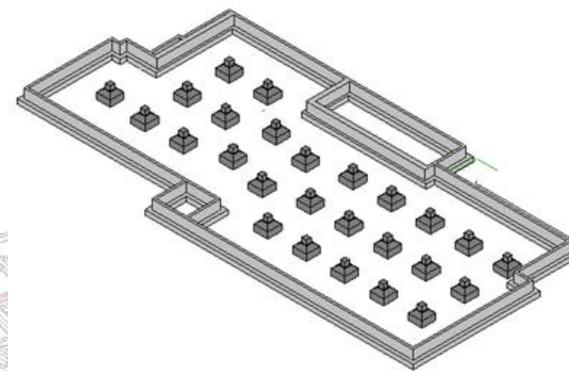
Isométrico de fundación muro perimetral corrido y fundación aislada al interior. Elaboración propia.
